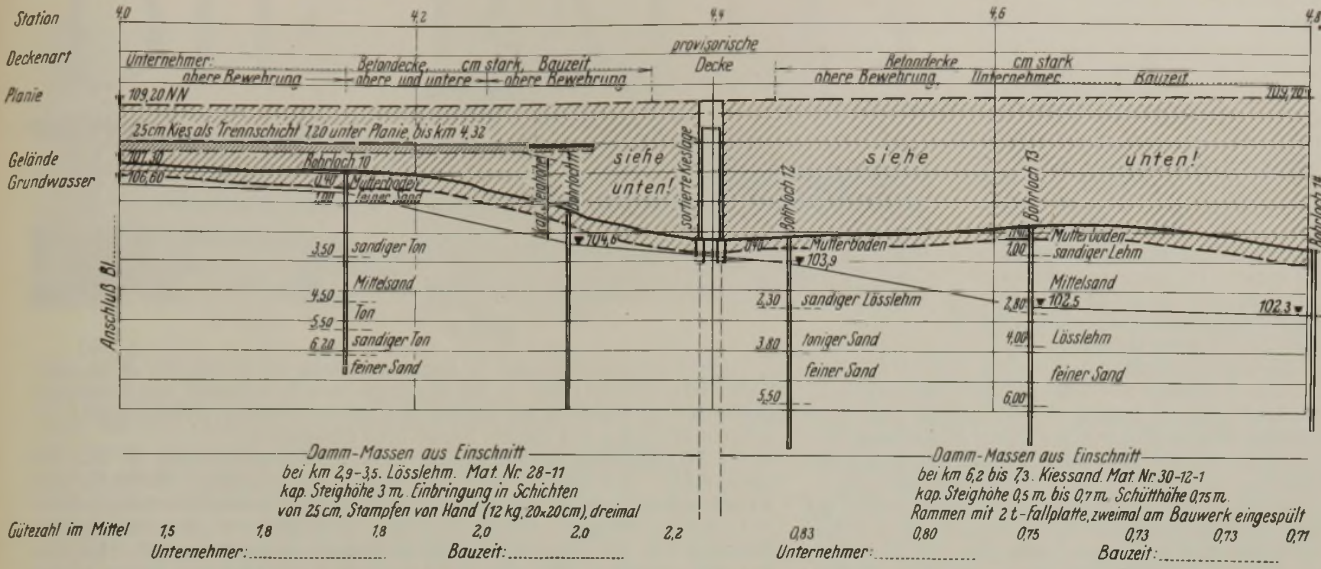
Geotechnische Baugeschichte. Muster für die Aufzeichnungen.
